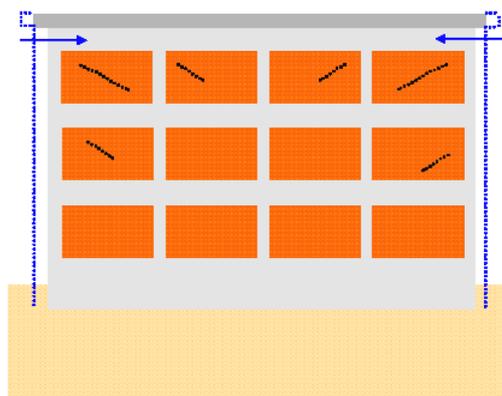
Fissuras devido ao corte em paredes por retracção da estrutura
